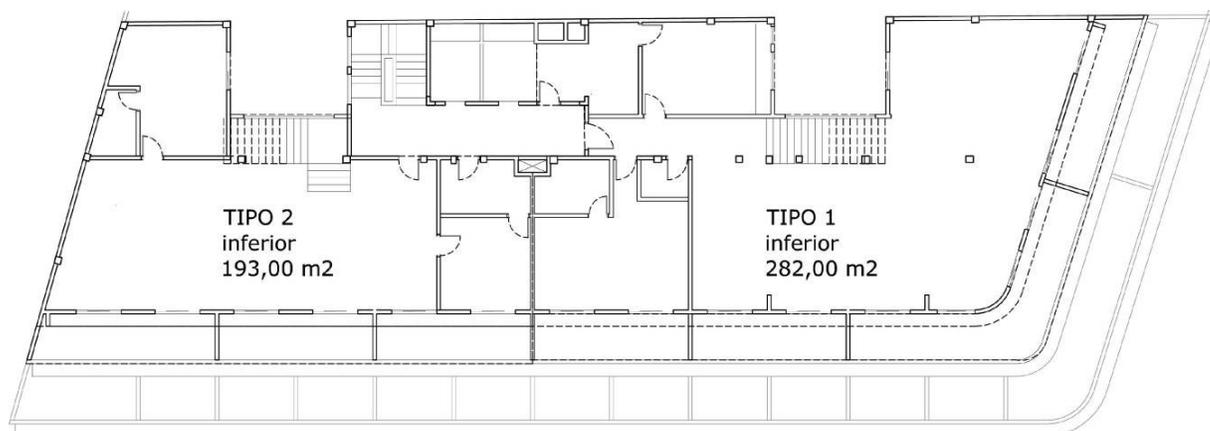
10 e (11º pavimento | Cobertura piso inferior)
